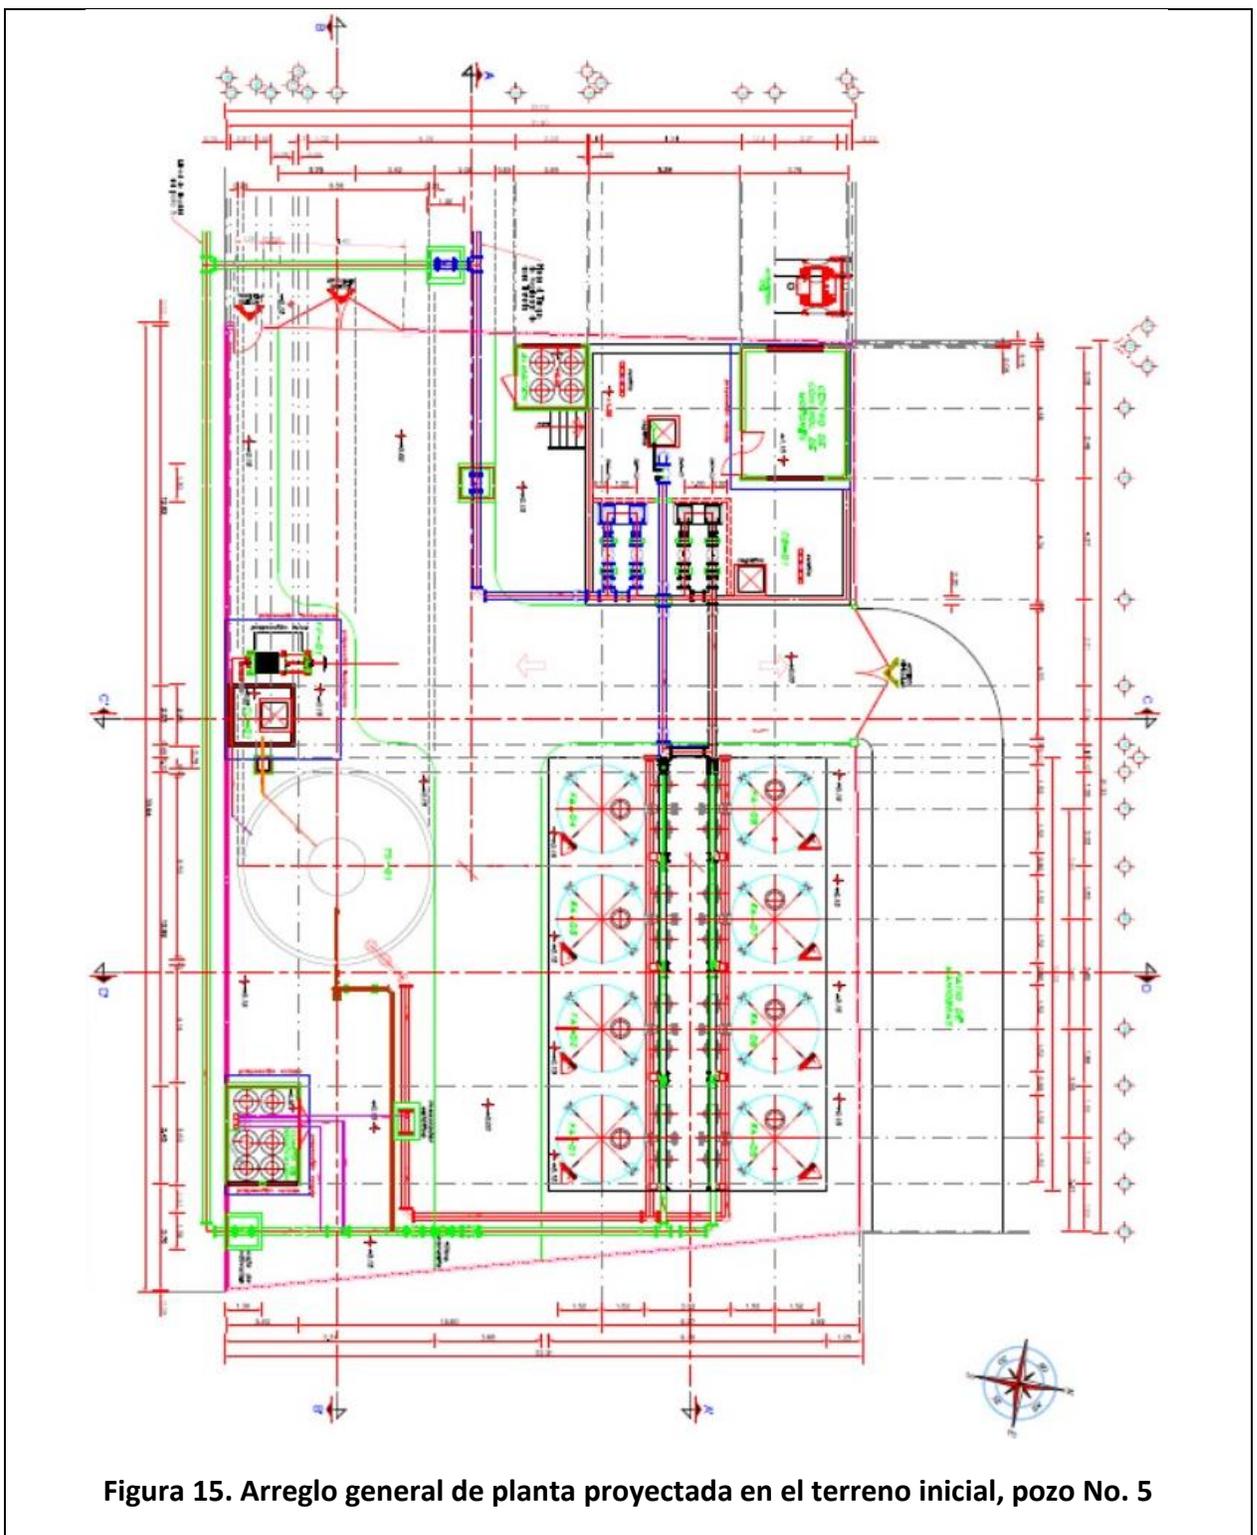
Arreglo general de planta proyectada en el terreno inicial, pozo No. 5
